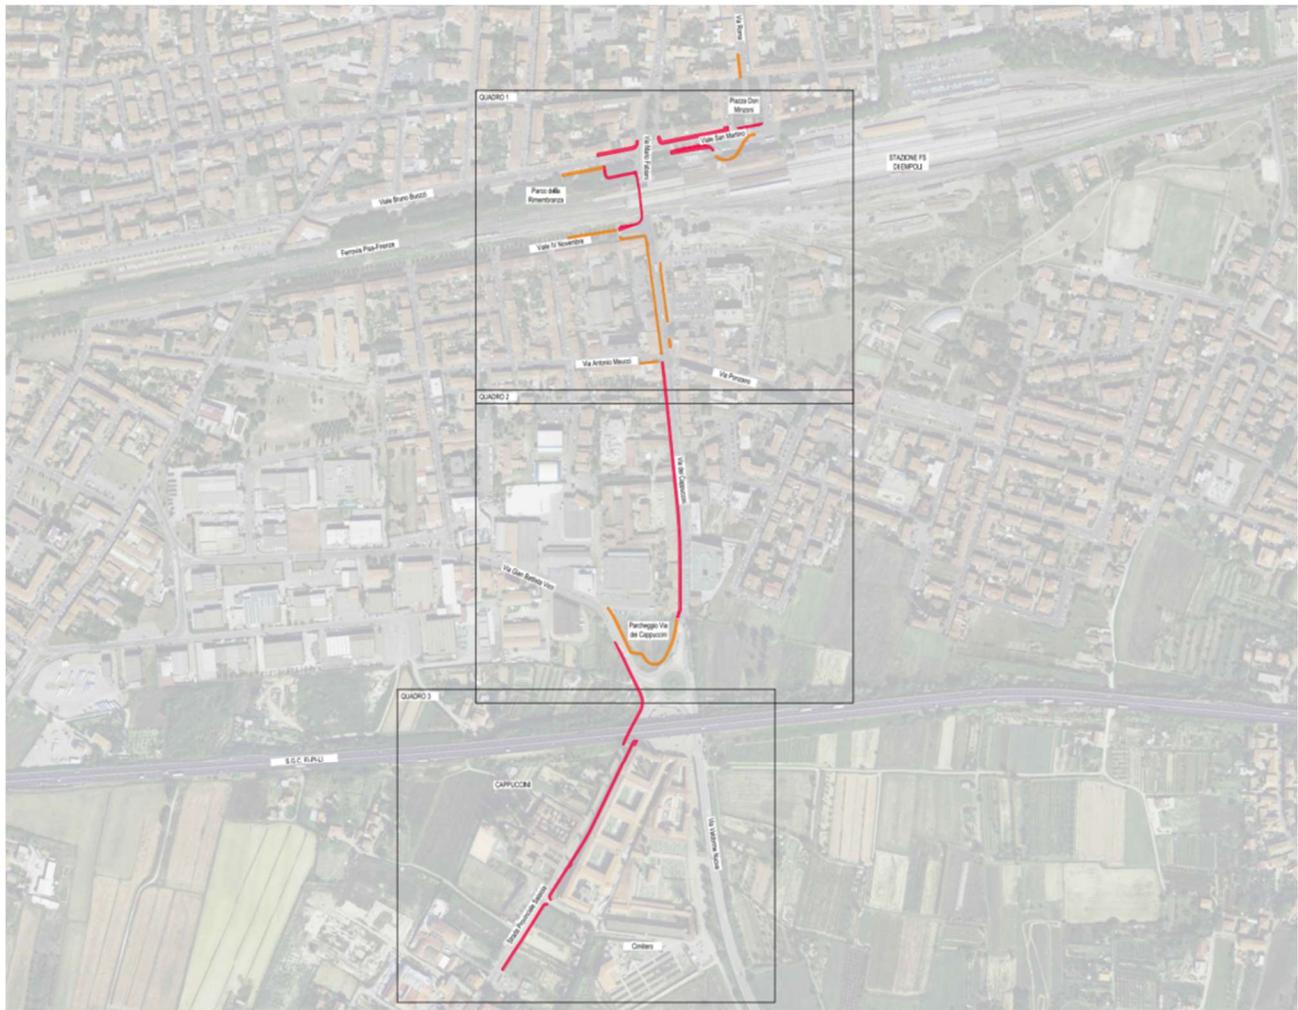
Planimetria piste ciclabili esistenti e di progetto
